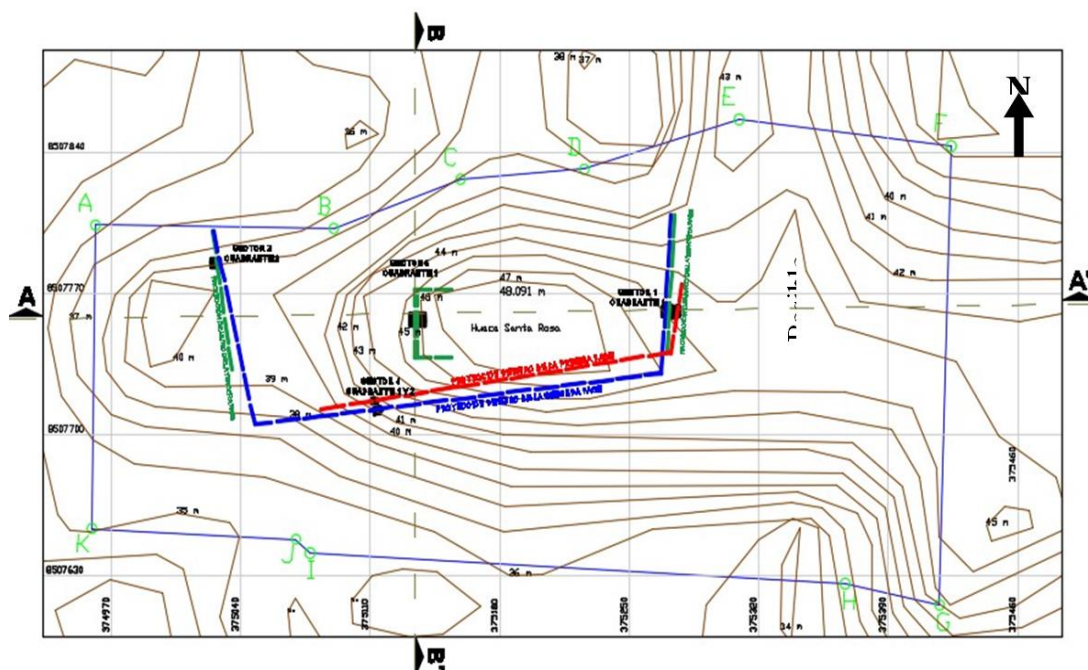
Plano general de la Huaca Santa Rosa y la proyección del Corte A-A' y B-B'.
